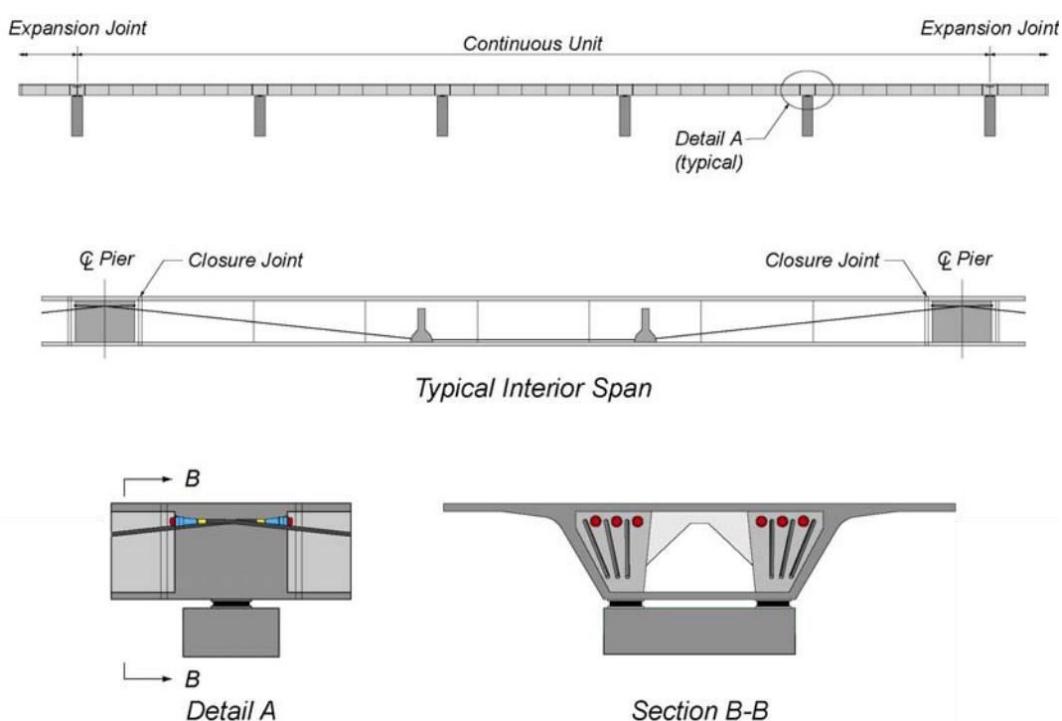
Post-tensionado del tramo interior para la construcción tramo-por-tramo.
